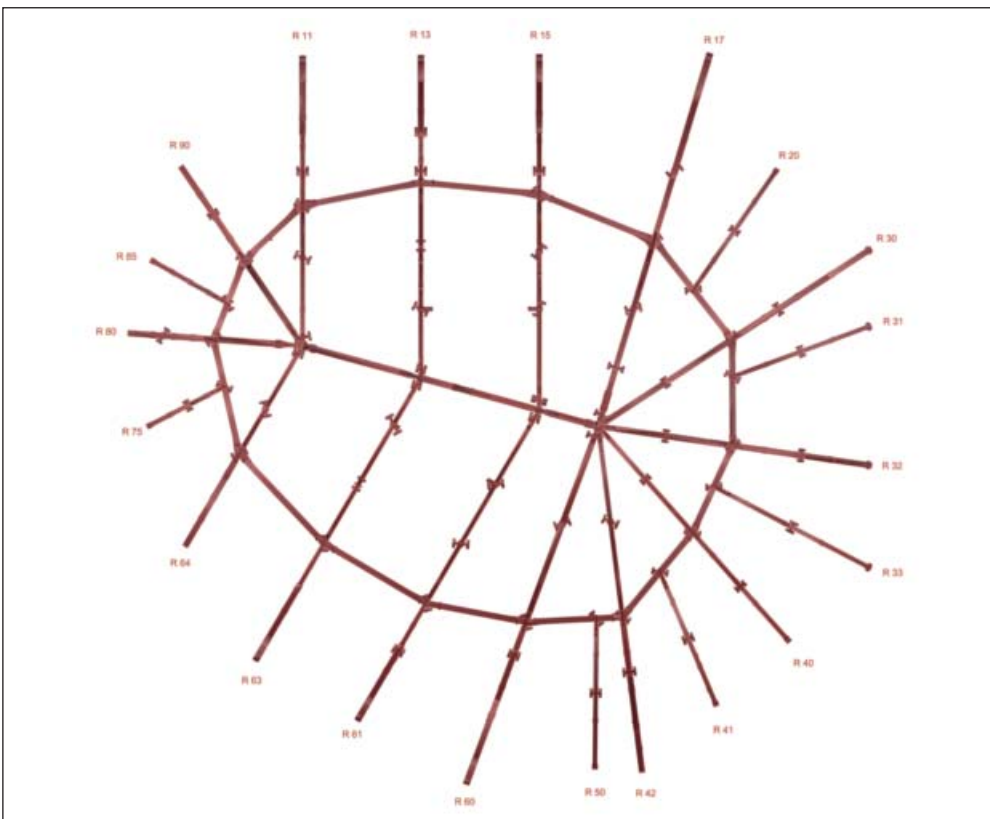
Teilmodell des Saaldach-fachwerks im Grundriss
